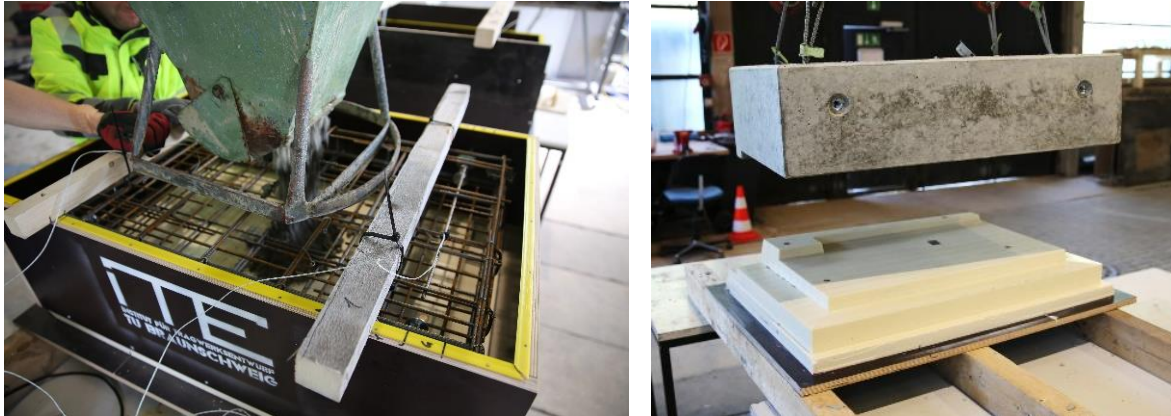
Betonierung des mit einer Randabschalung und einem Bewehrungskorb versehenen Wachs-Schalungselements (links), Abheben des betonierten Muster-Fertigteilbalkons (rechts)
